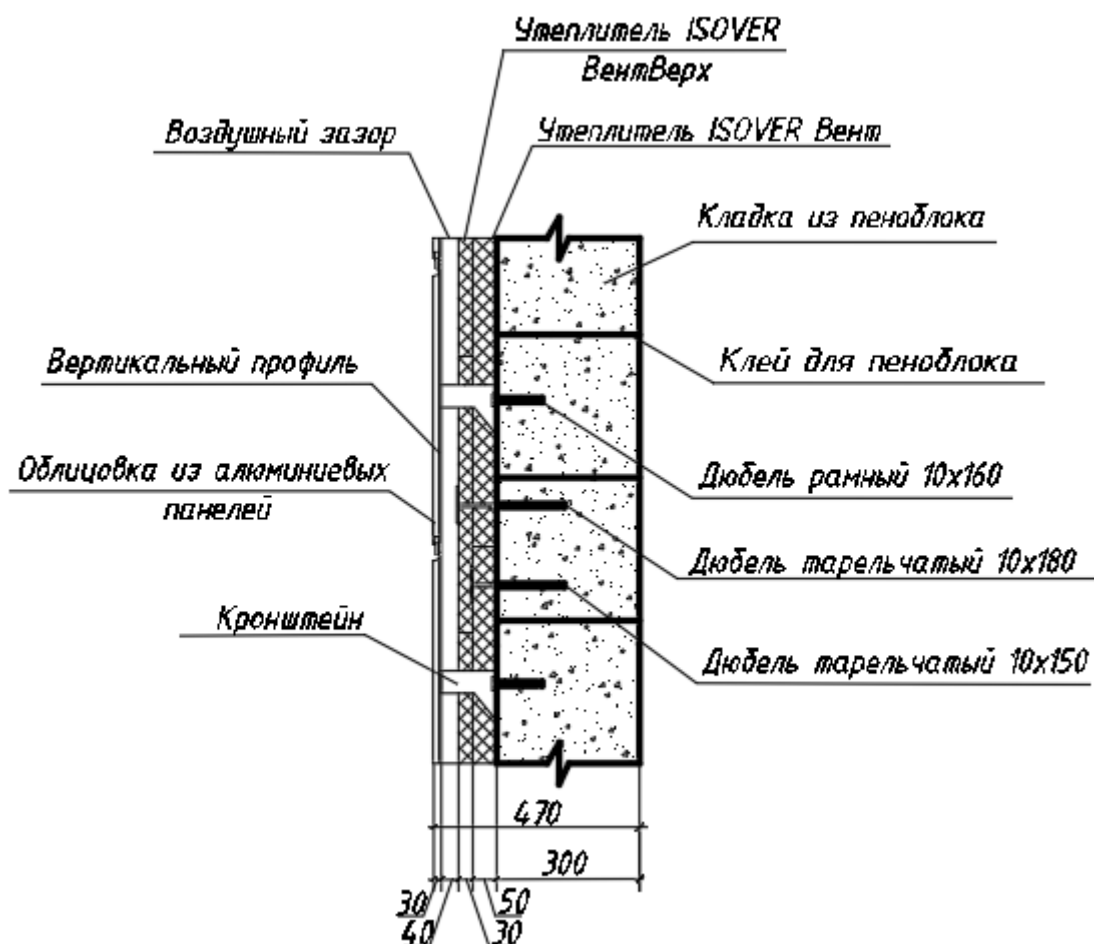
, пример ограждающей конструкции из ячеистобетонных блоков с вентилируемым фасадом.
